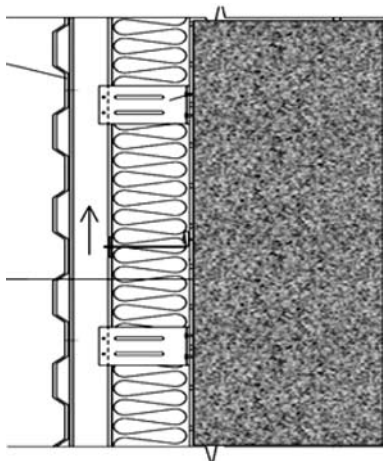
Отделка стен из автоклавного газобетона при помощи навесного вентилируемого фасада
